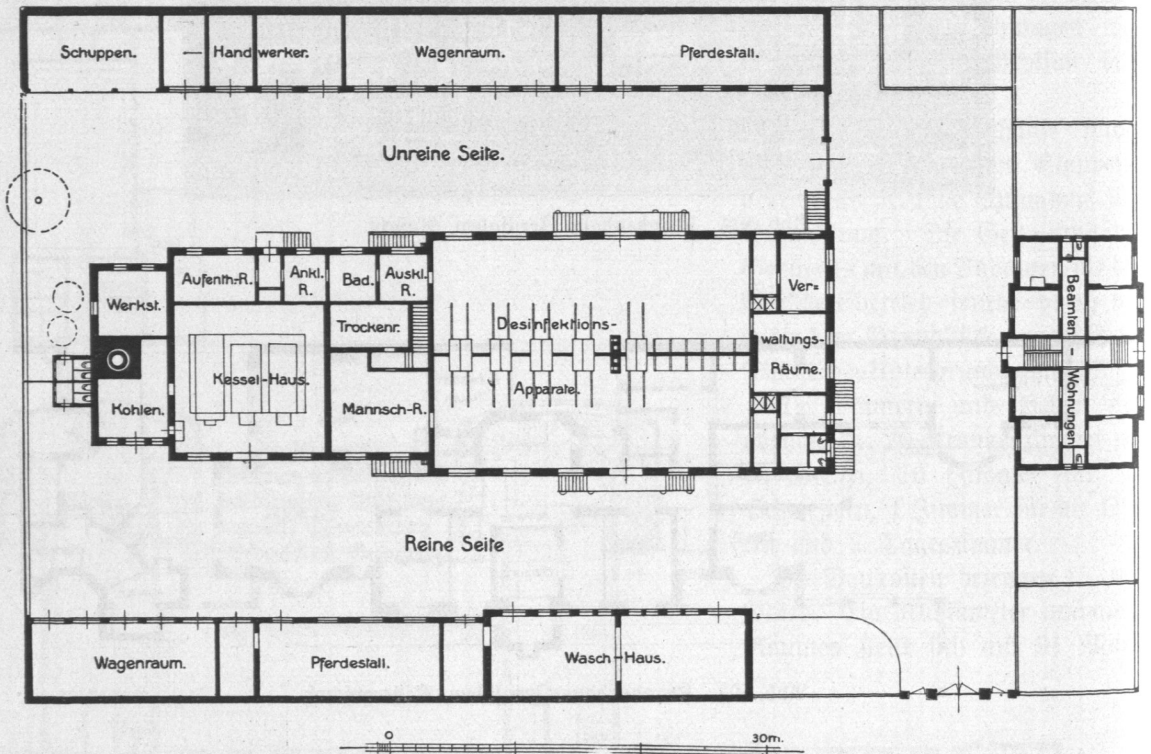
Desinfektionsanstalt I am Bullerdeich, Lageplan.
